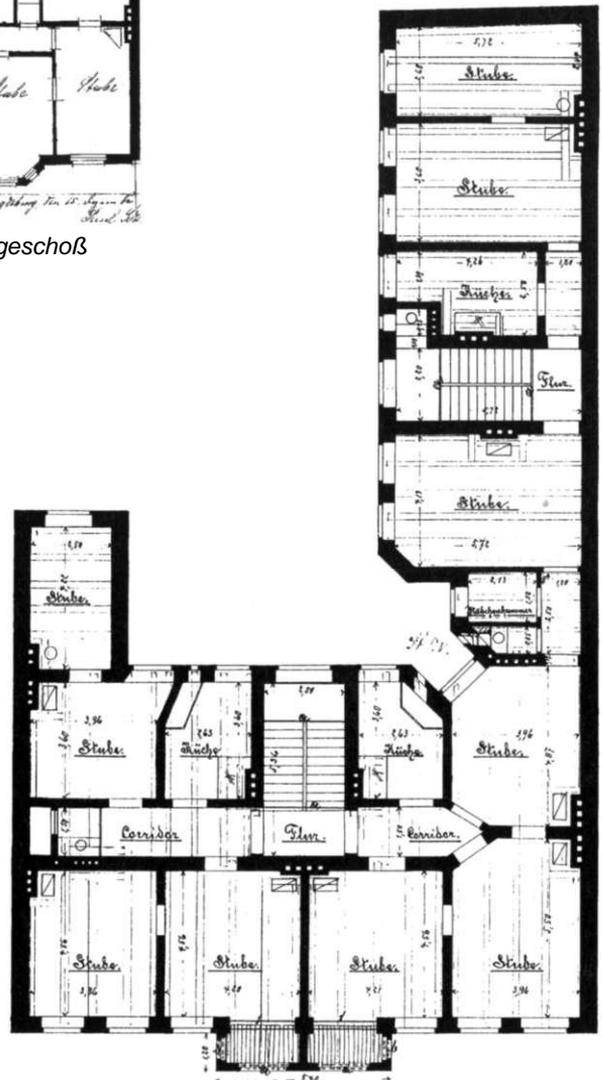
Grundrißtyp K, Annastraße 37, 1. Etage
